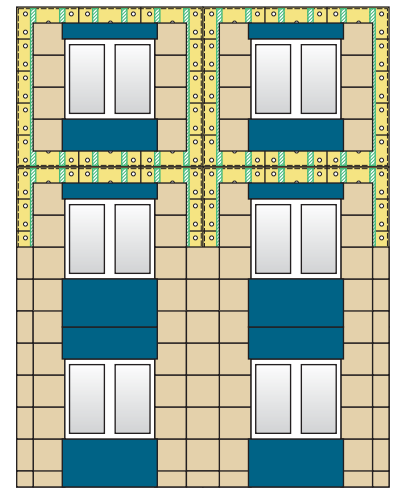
Фрагмент фасада здания, возведенного методом укрупнительной сборки
